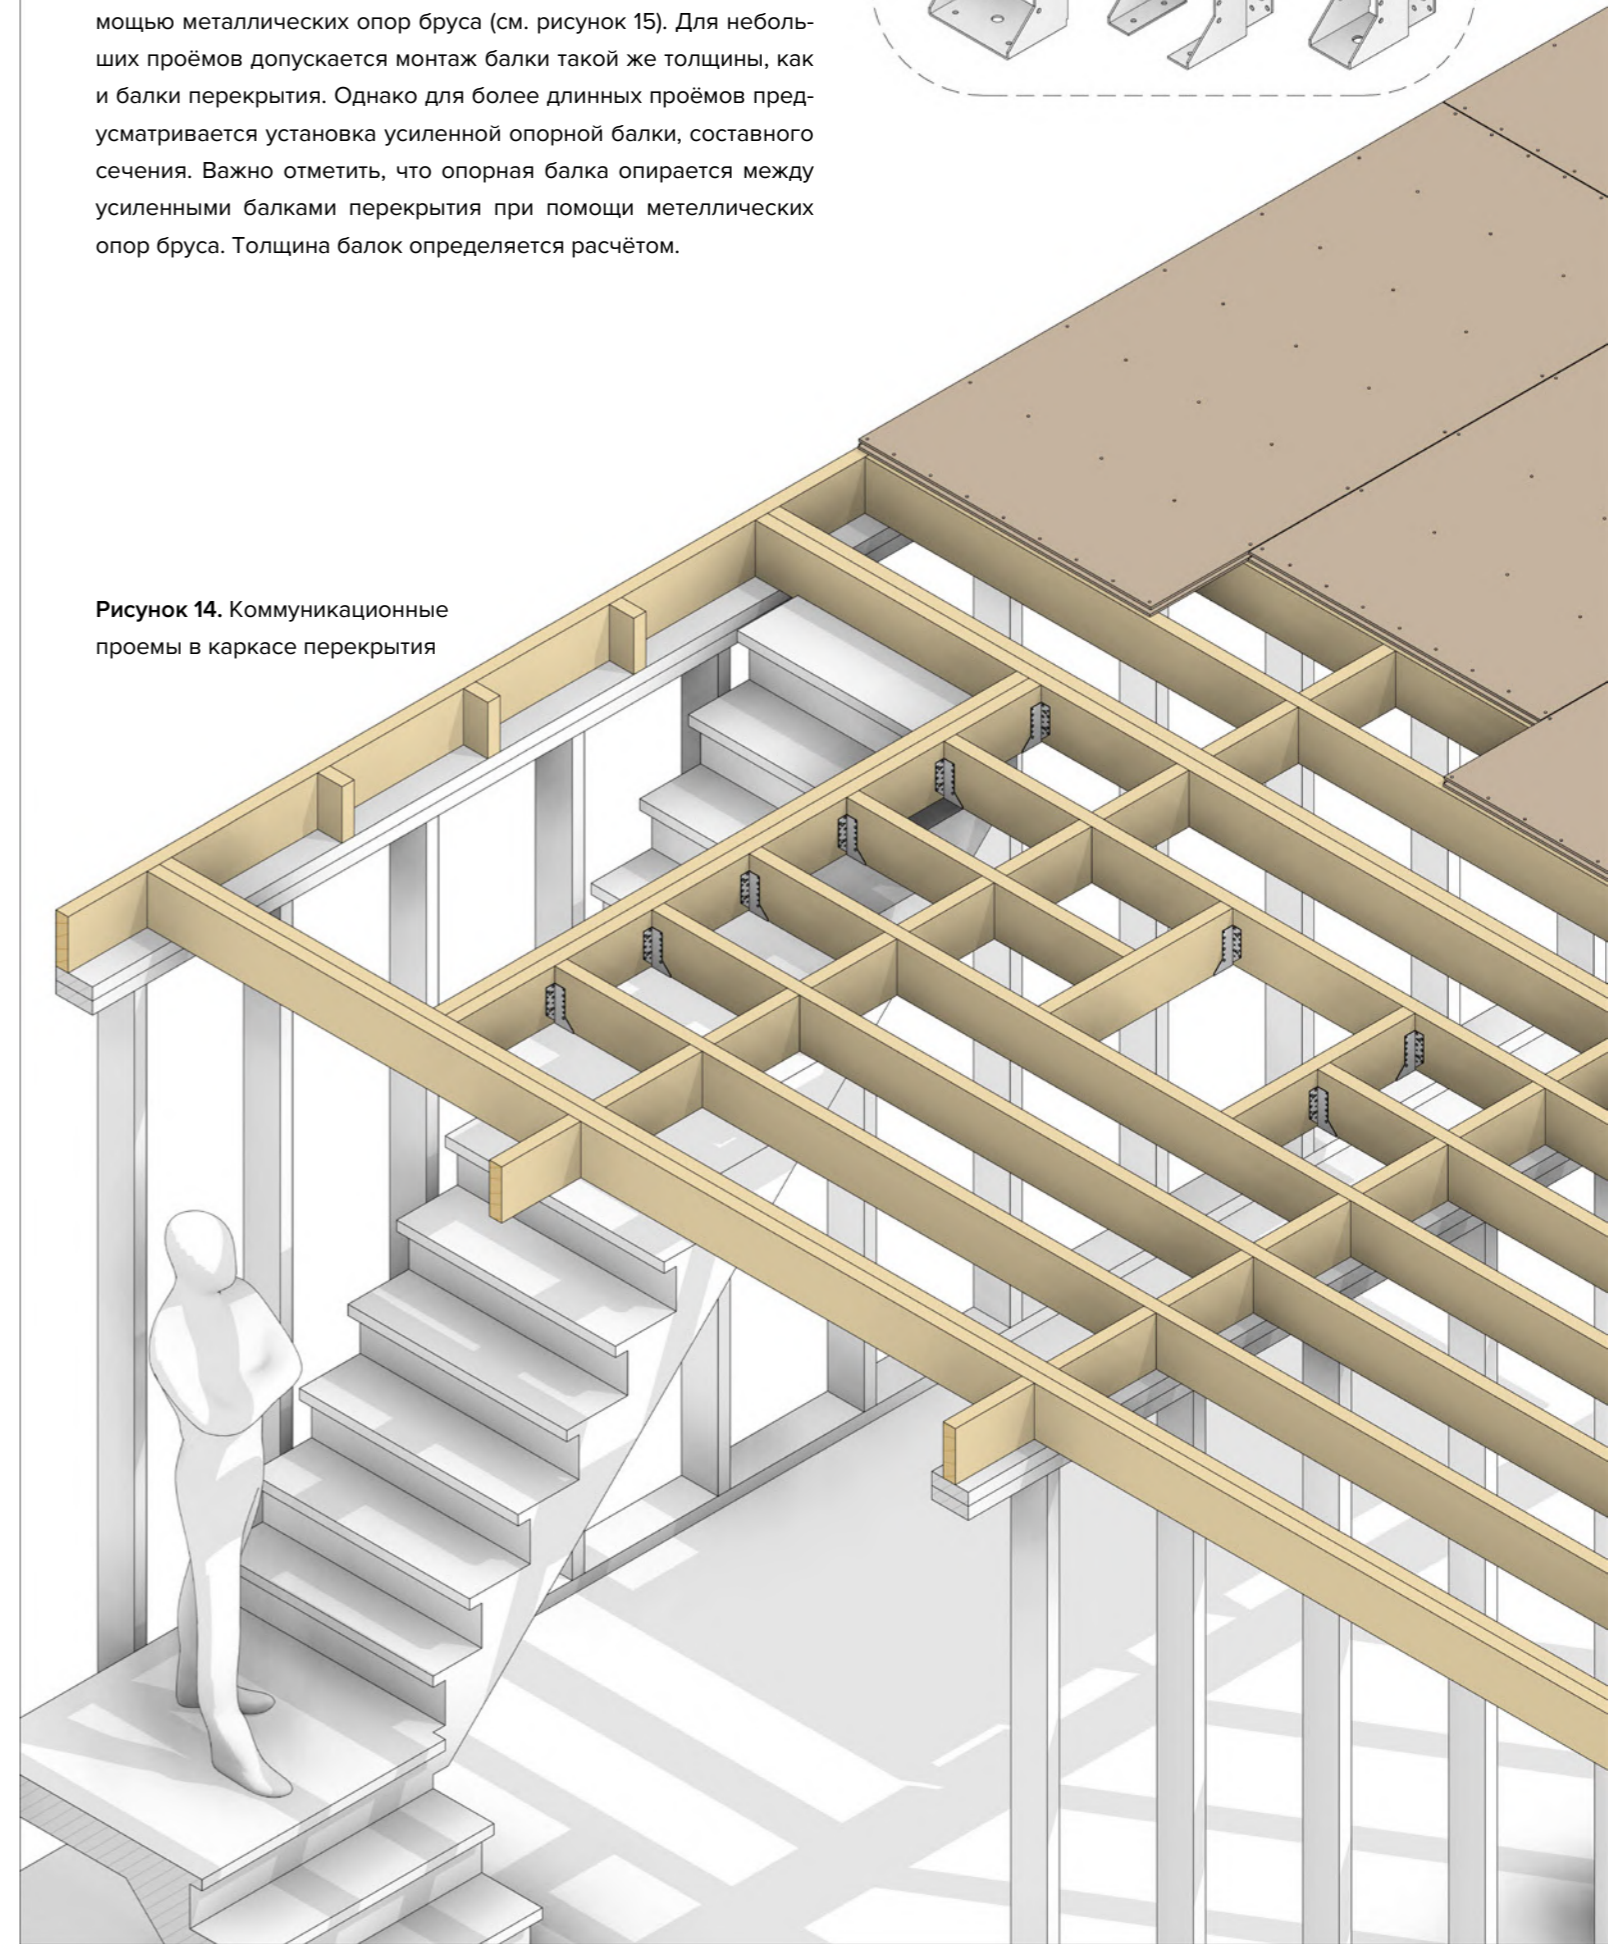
Коммуникационные проемы в каркасе перекрытия
